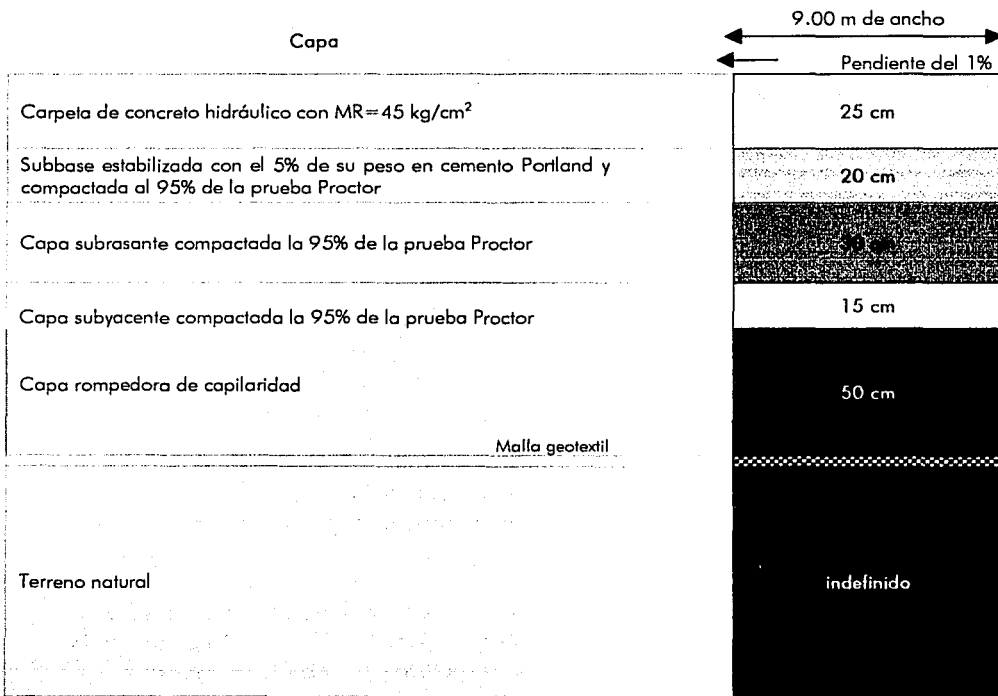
Sección transversal para el pavimento del tramo con capa rompedora de capilaridad.
